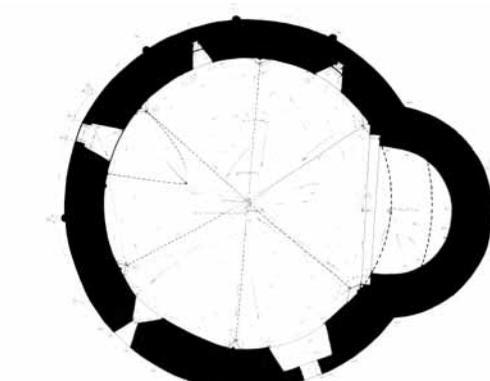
Grundriss Hadersdorf, M 1:200. Planarchiv des BDA Wien.
